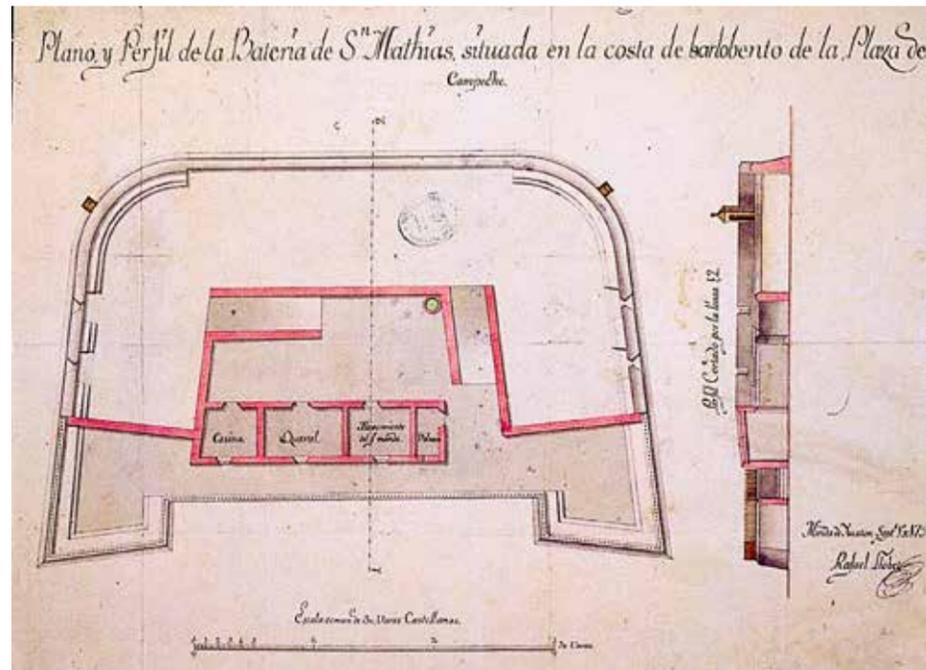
Plano de la Batería de San Matías por Rafael Llobet, 1792.
